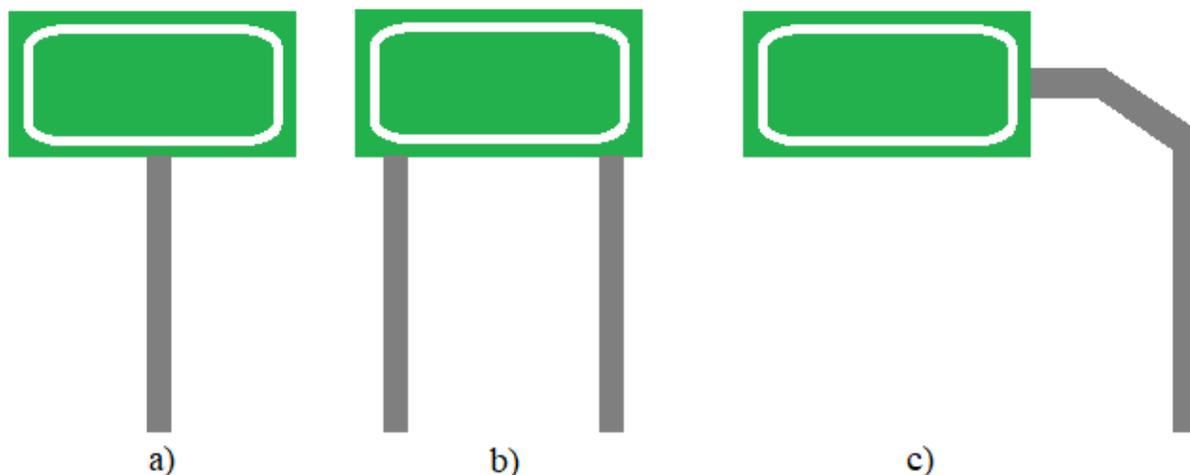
a) poste do tipo coluna; b) coluna dupla; c) braço projectado (Fonte: Autor)
